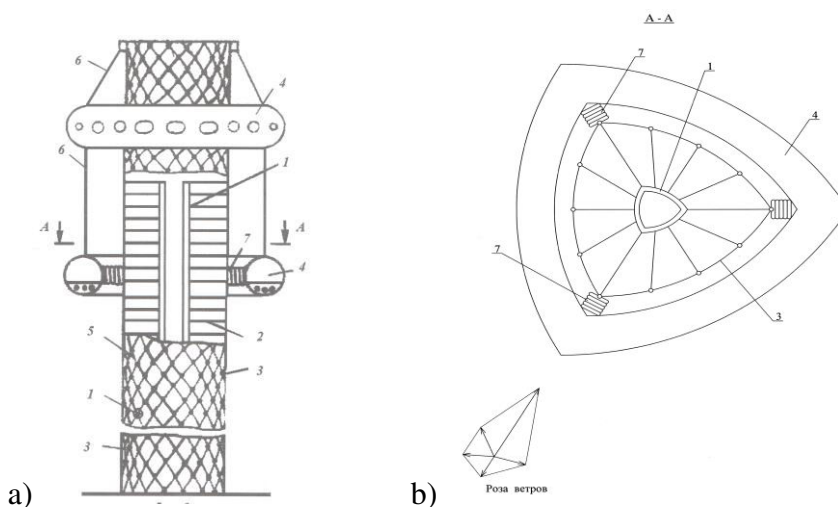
Многоэтажное здание с ядром жесткости: а- вертикальный разрез здания; б- поперечный разрез А-А здания.
